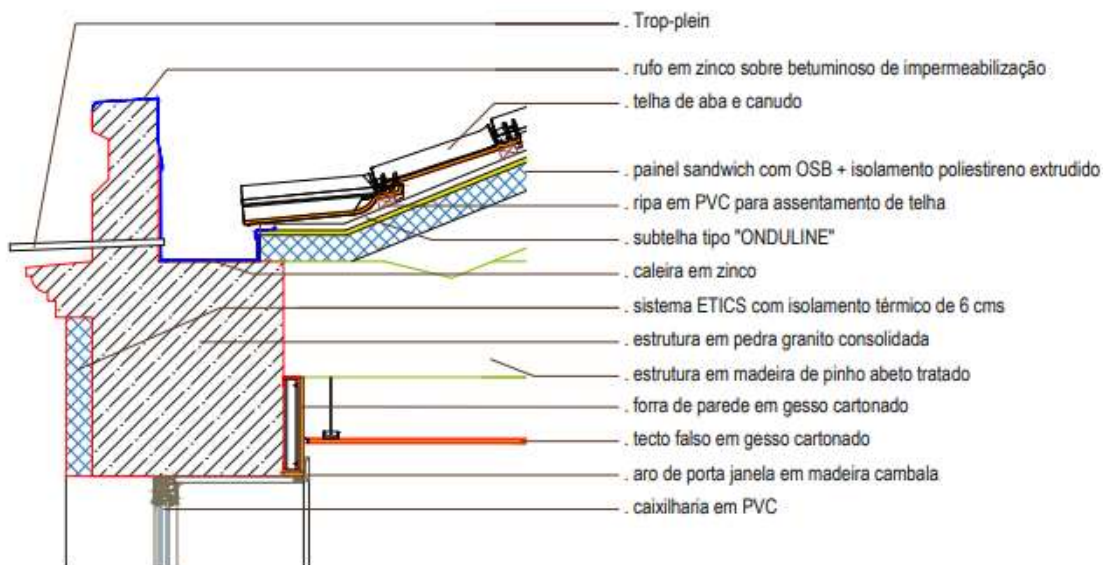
Pormenor da platibanda e sua impermeabilização.
